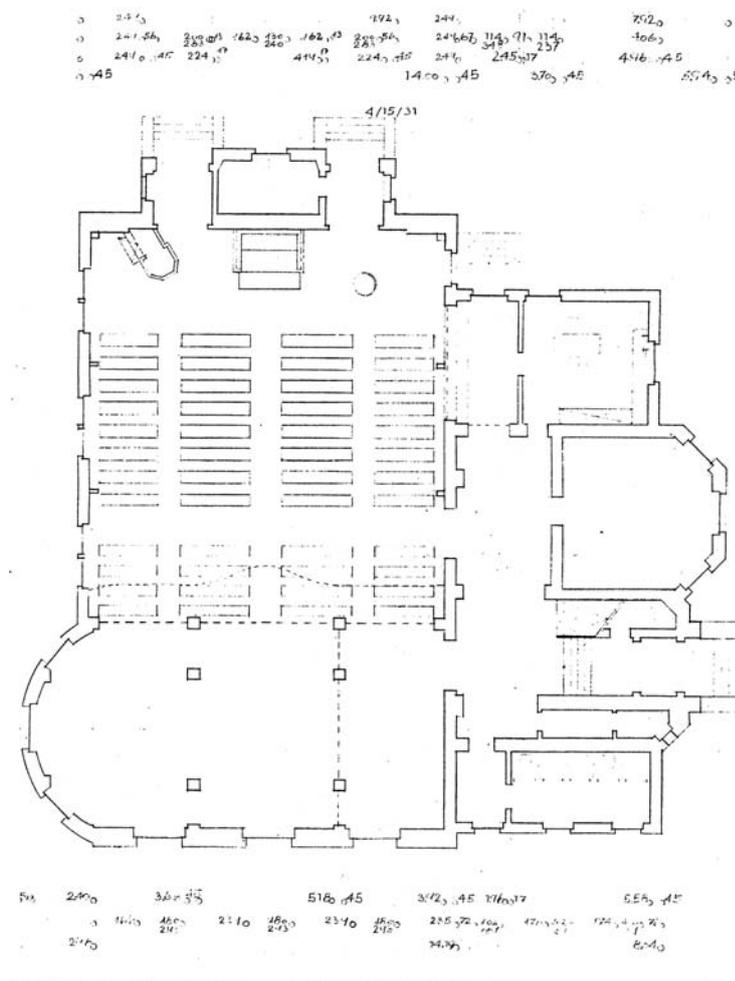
Grundriss Erdgeschoss, Zustand bis vor 1960
